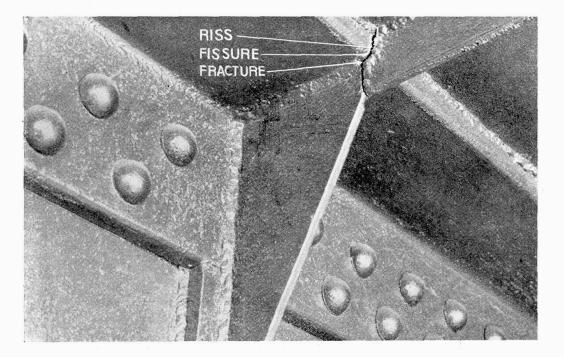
Gerissene Schweißung. — Soudure fissurée. — Fractured weld.
